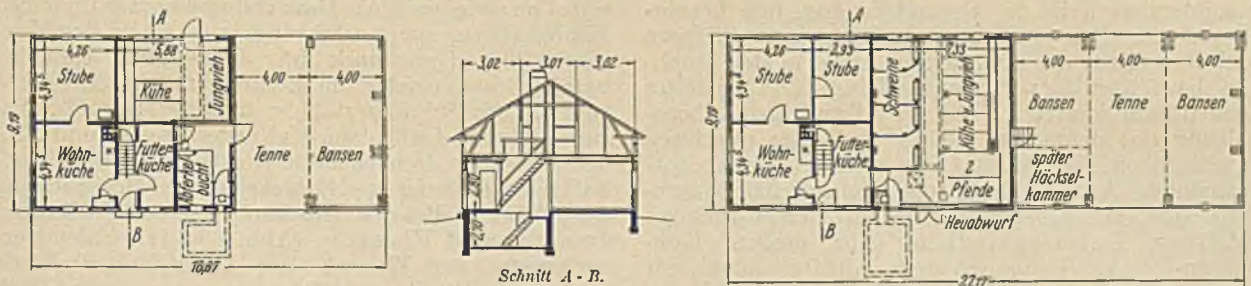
Kuhbauern- und Vollbauernstelle in Holzbauweise. M. 1:400.
